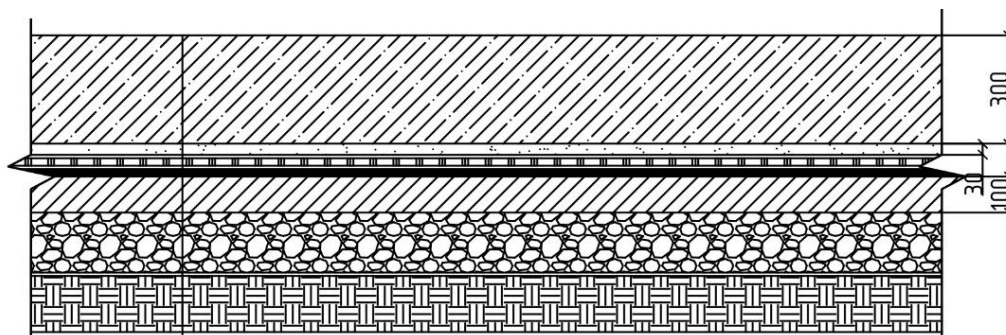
Узел 1-1. Узел фундамента с примыканием плиты перекрытия
